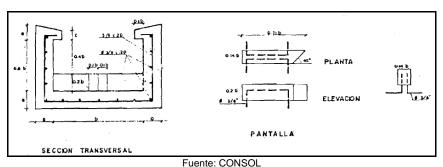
Detalle Sección Transversal y Pantalla Estructura de Bajada
